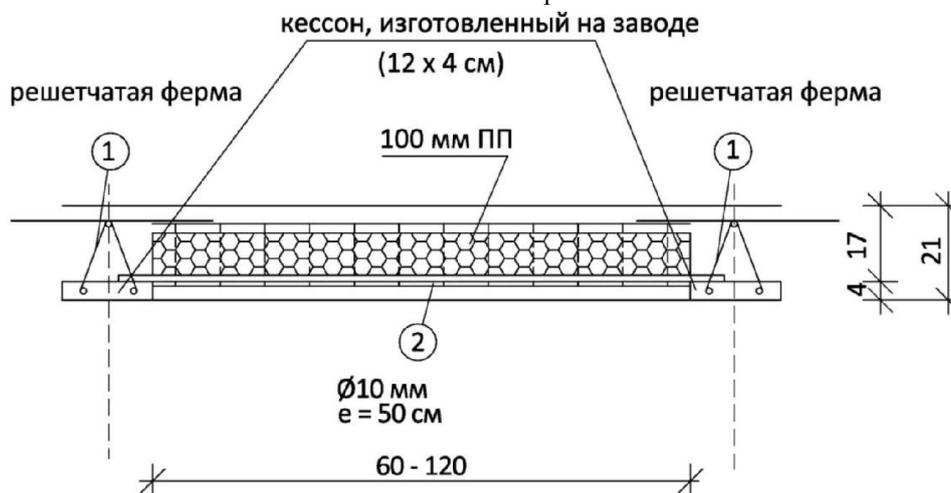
Решетчатые фермы с бетонным кессоном, изготовленным на заводе.
